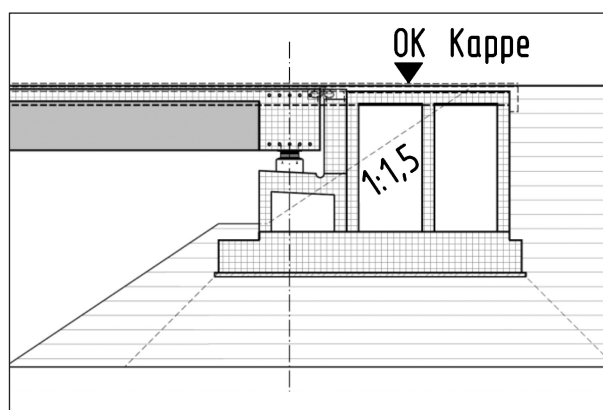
Schnitt, Stahlbetonhohlquerschnitt, hochgesetztes Widerlager auf Bodenaustausch
